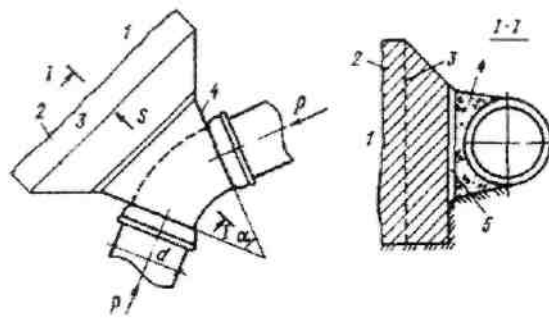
Упори для чавунних розтрубних підземних у разі повороту в горизонтальній площині: 1 – непорушений ґрунт; 2 – опорна поверхня; 3 – тіло упору; 4 – подушка з бетону; 5 – толева перекладка у два шари
